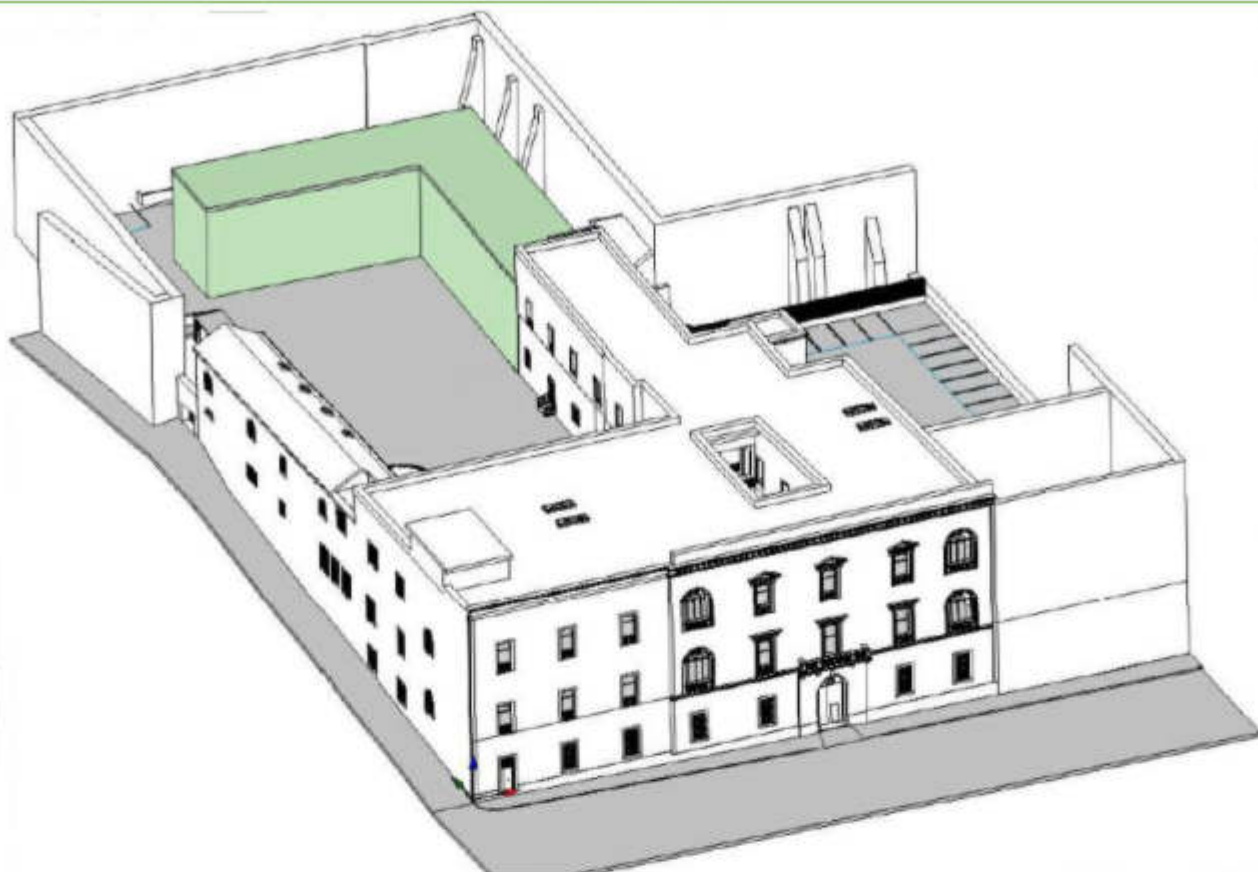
Modello informativo BIM - Vista Assonometrica Alternativa n°02
